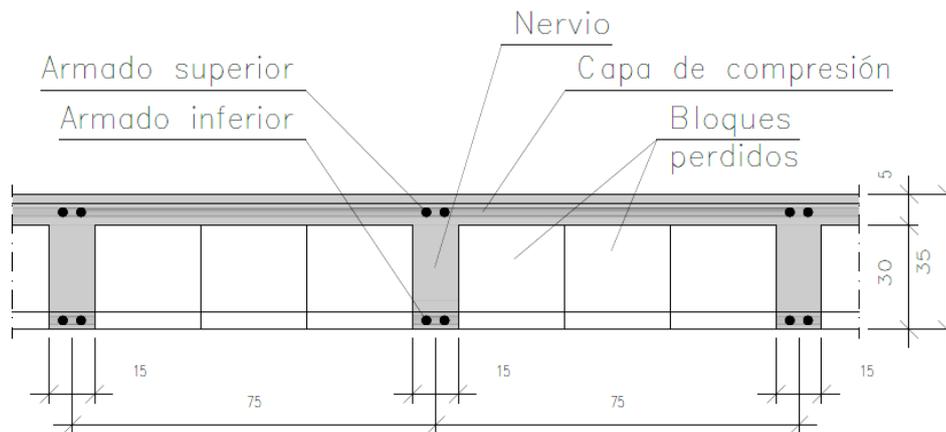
Sección losa casetonada. Fuente: Elaboración propia.
